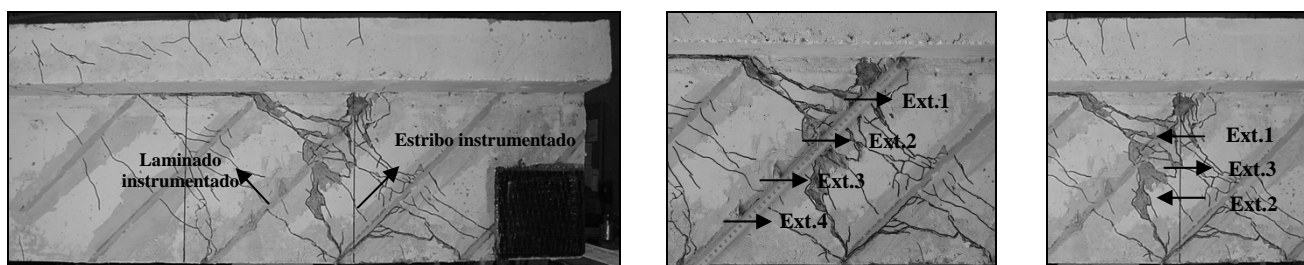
Localização dos extensômetros no laminado e estribo instrumentados da viga 2S-5LI45-A.
